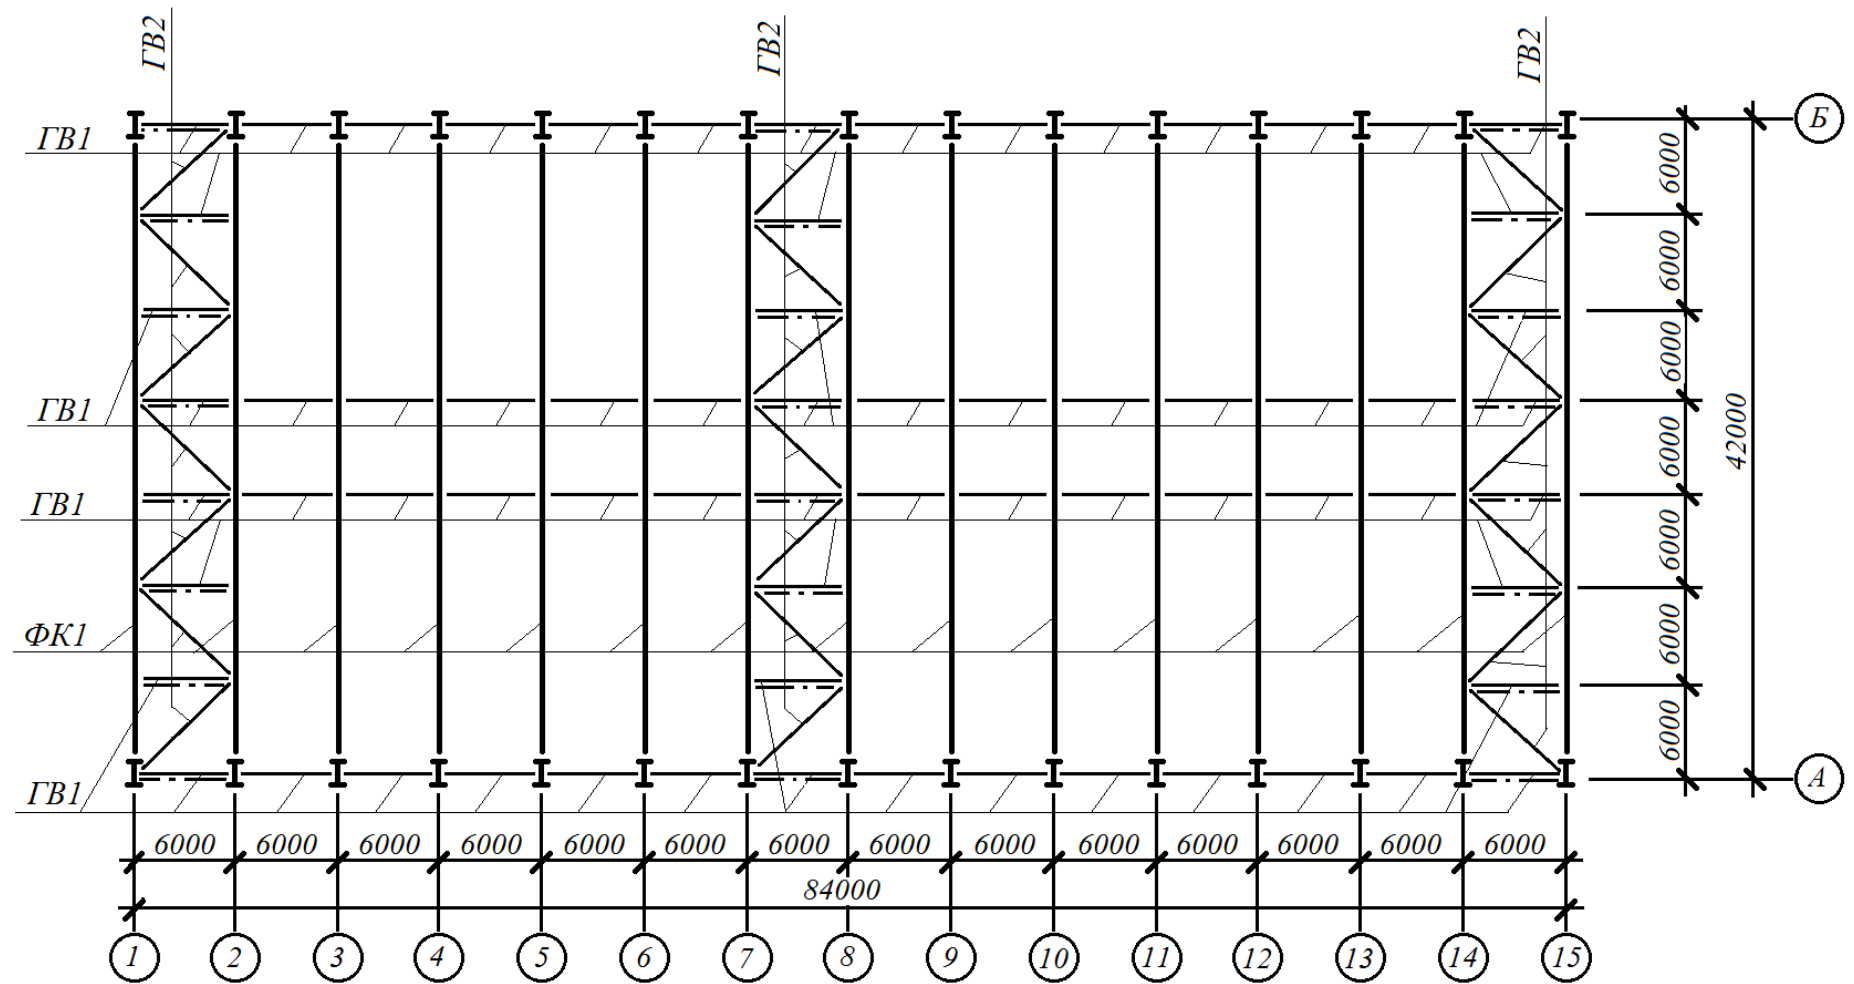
План в'язей по верхніх поясах кроквяних ферм.
